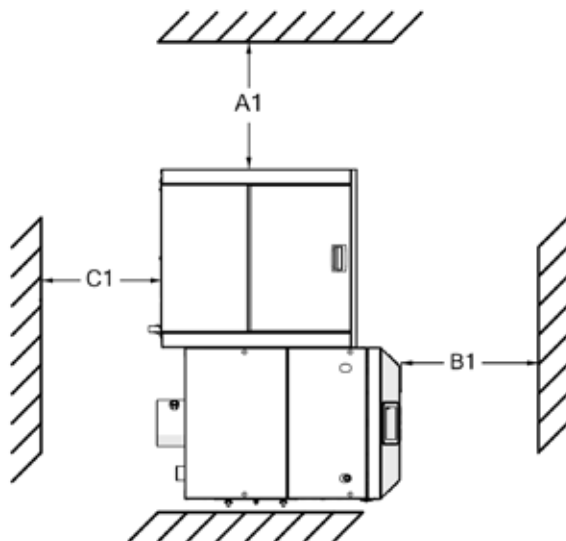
Габаритная схема расположения котла в котельной (вид сверху, исполнение: бак правый)
